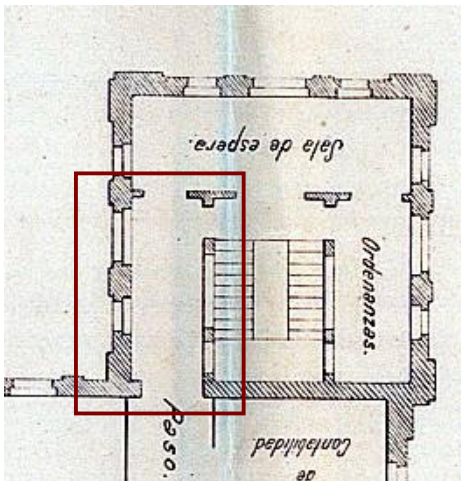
Detalle planta zona acceso planta primera. Torreón izquierdo. (FFE-2008).
